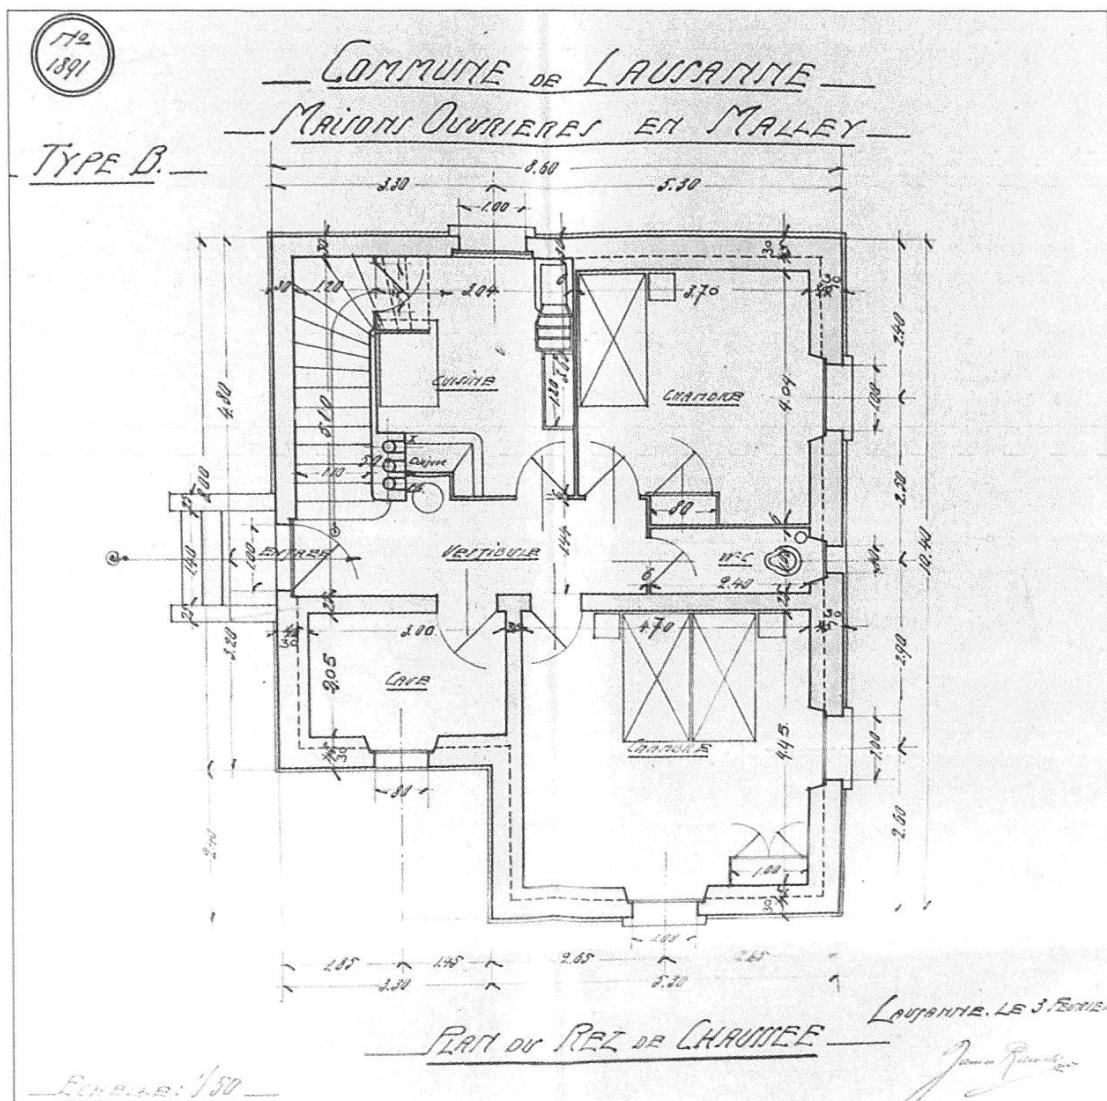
Plan du rez-de-chaussée, type B, James Ramelet architecte, 3 février 1913, 1:50 (Police des constructions de la commune de Renens). À noter la présence de la cave, dans l'angle donnant au sud, et de l'escalier empiétant sur l'espace de la cuisine.
